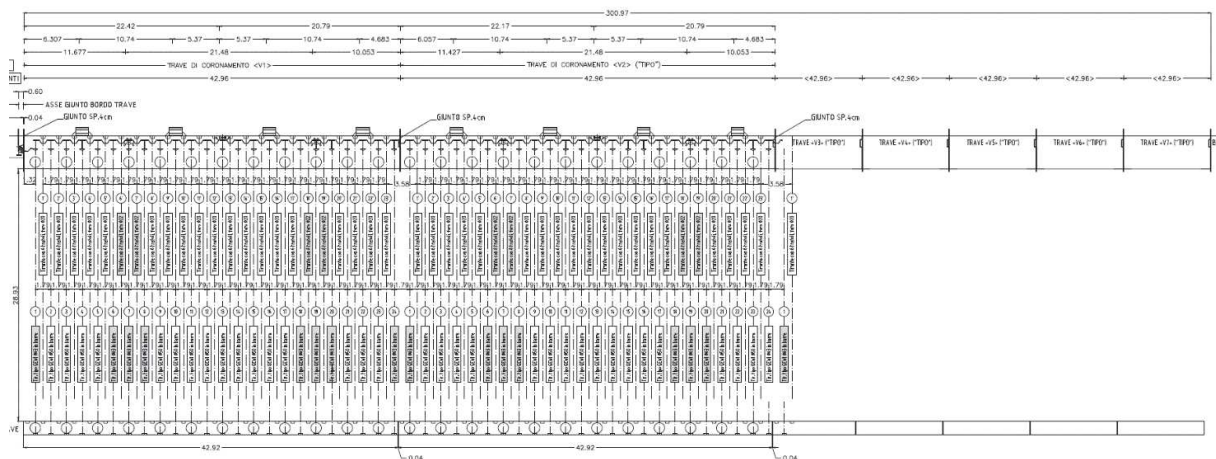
Estratto da PE 2° perizia di variante e suppletiva - T001 Planimetria generale
